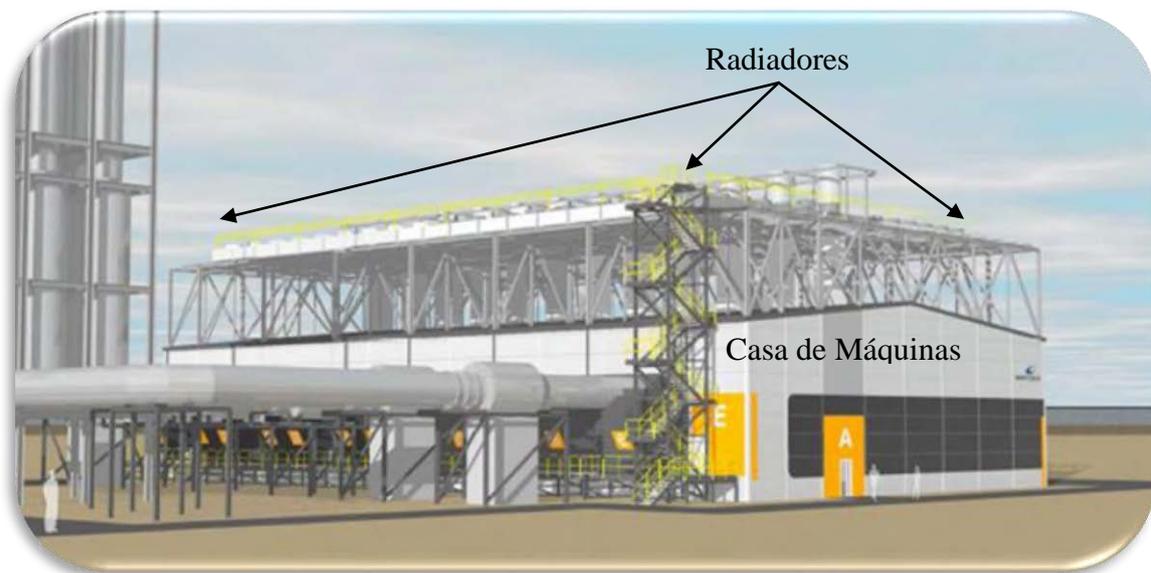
Vista geral da planta – radiadores - Fonte: WÄRTSILÄ
